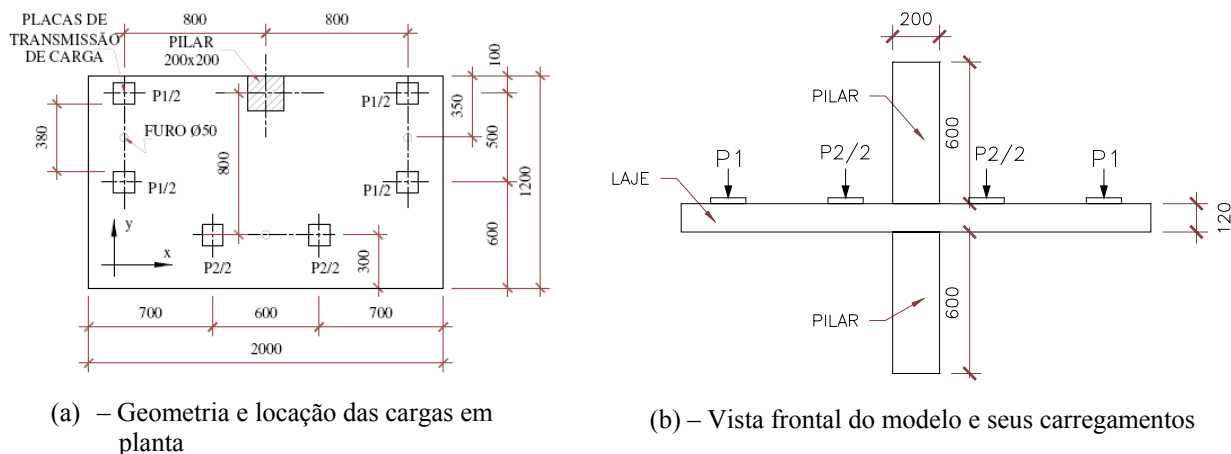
Lajes e pontos de carregamento – VILLAVERDE (2008).
